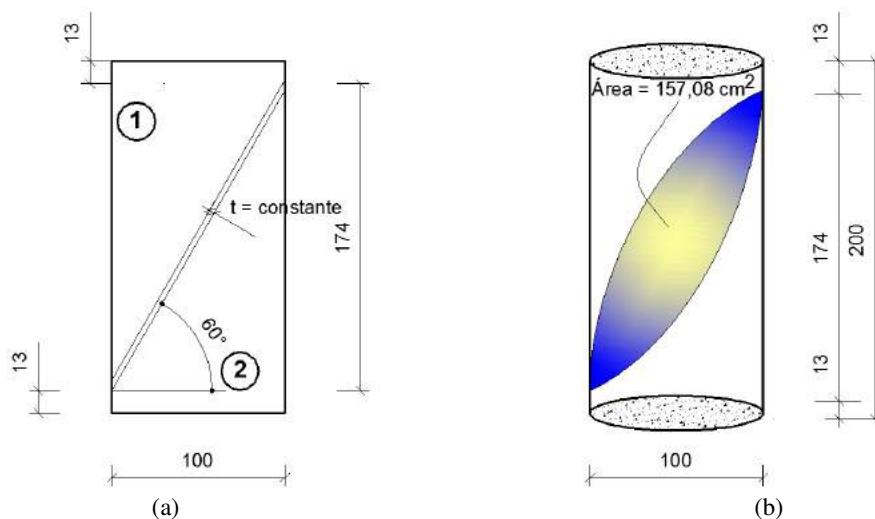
Determinação das tensões num plano a 60°: a) seção transversal do corpo de prova; b) dimensões do corpo de prova (medidas em mm).
